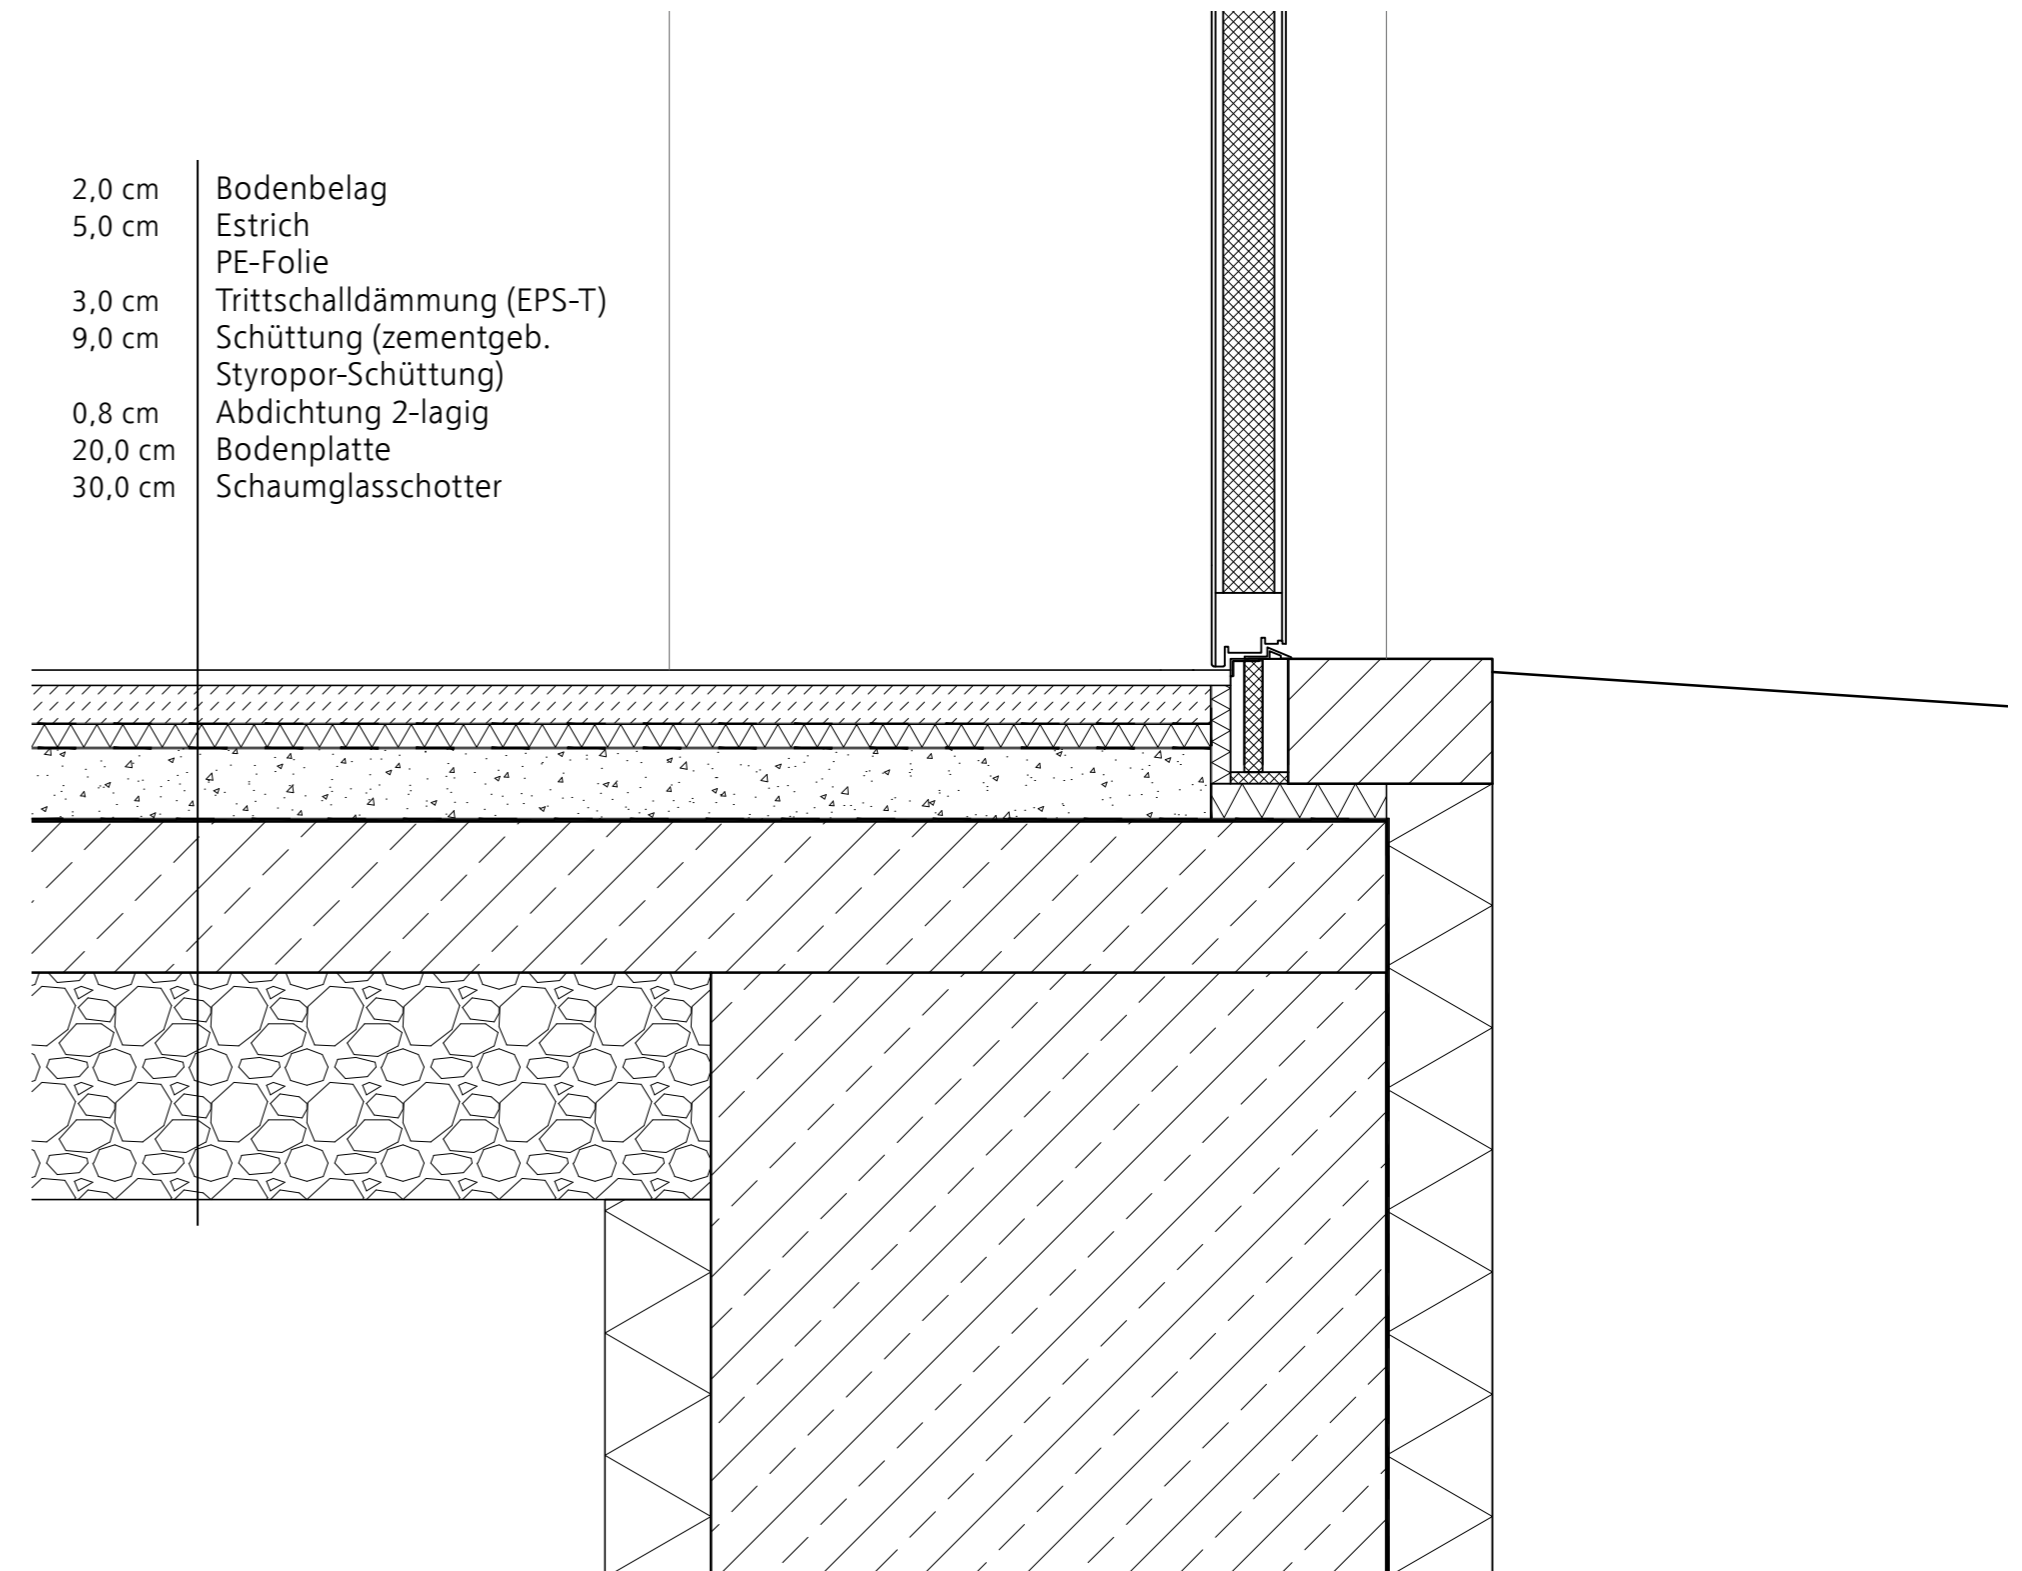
Fassadenschnitt Bodenplatte | M 1-10
